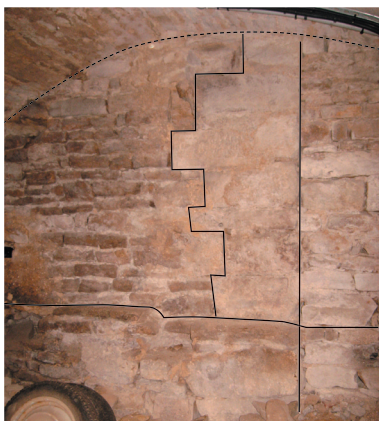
Cave du château Mur en harpe d'angle et niveau de fondation. © VBG
